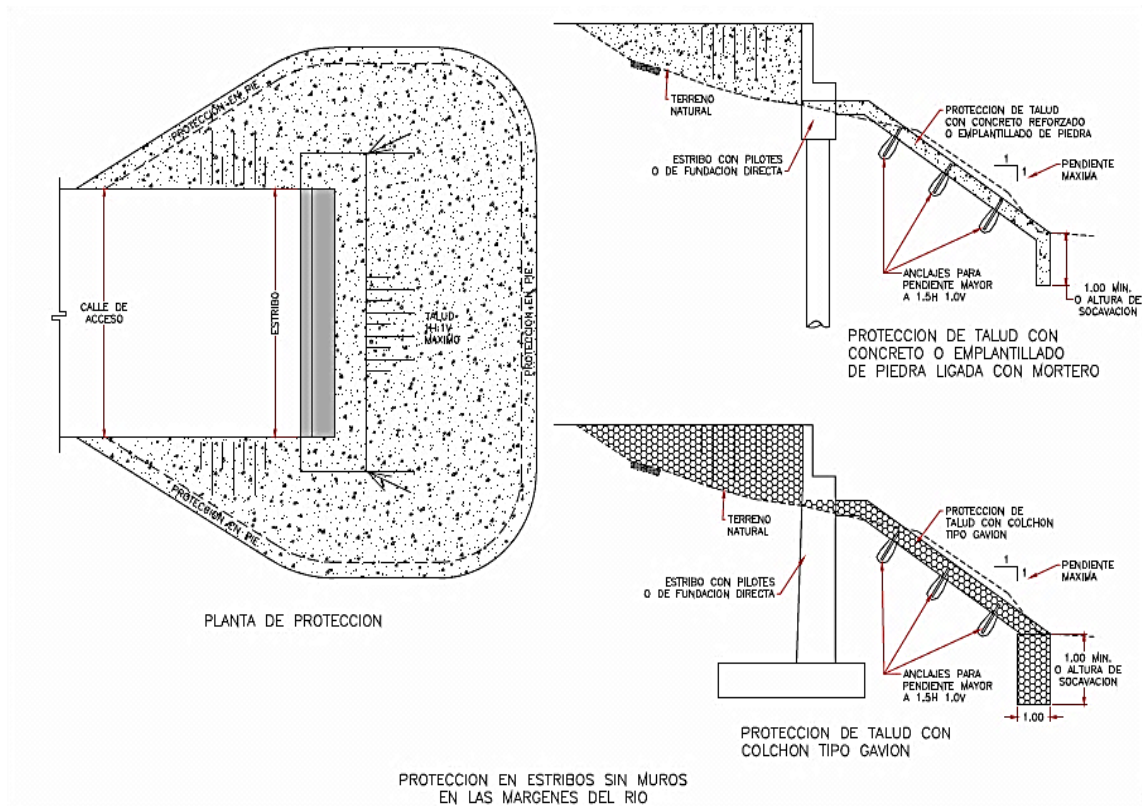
Protección para estribos sin muros en las márgenes del río, con anclajes.
